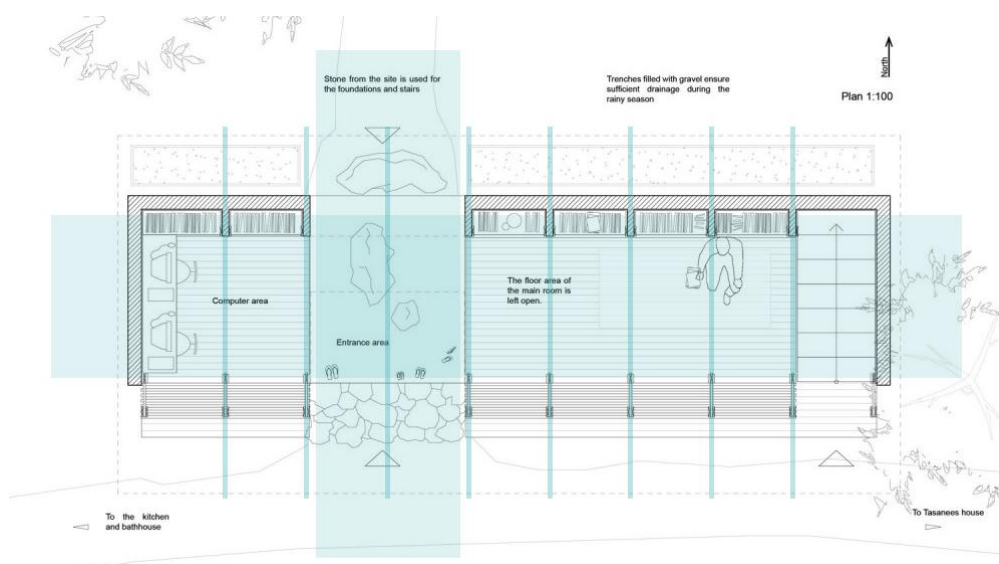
"Safe Heaven Library", planta. Alterações de autor.
